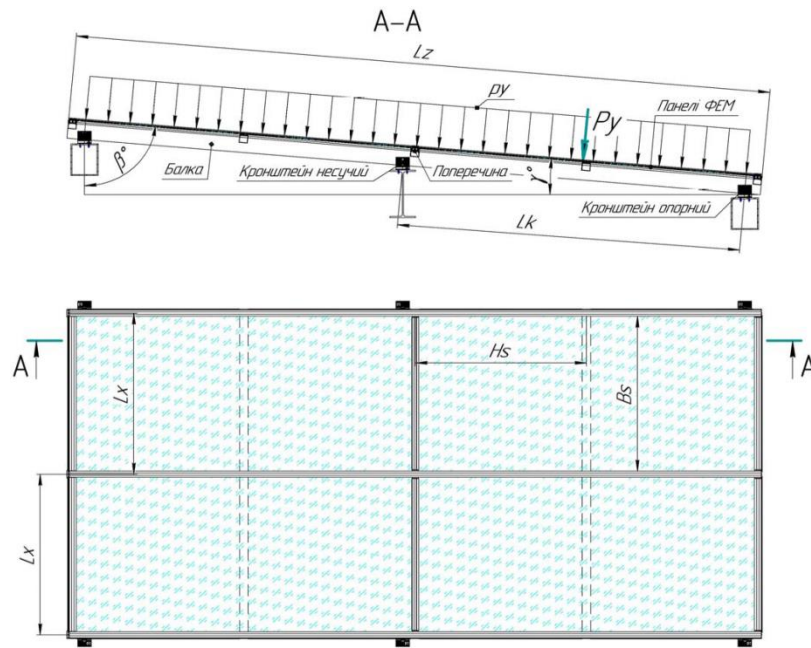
Розрахункова схема дії навантажень на панелі ФЕМ
